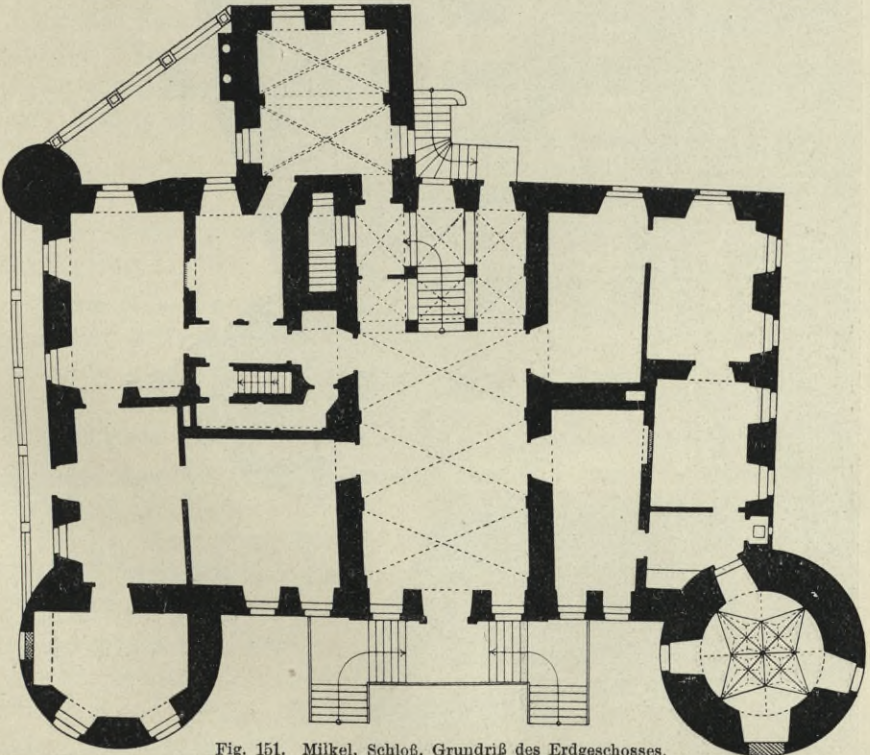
Milkel, Schloß, Grundriß des Erdgeschosses.
